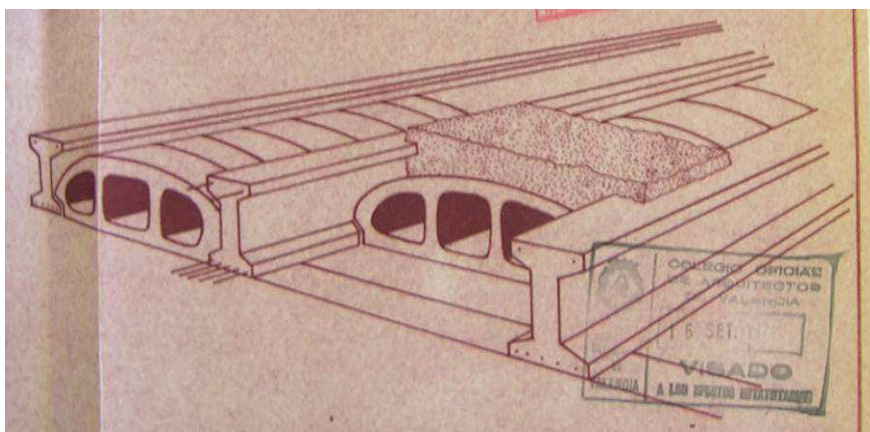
Detalle constructivo del forjado, Edificio ficha 221C.019, 1972.
